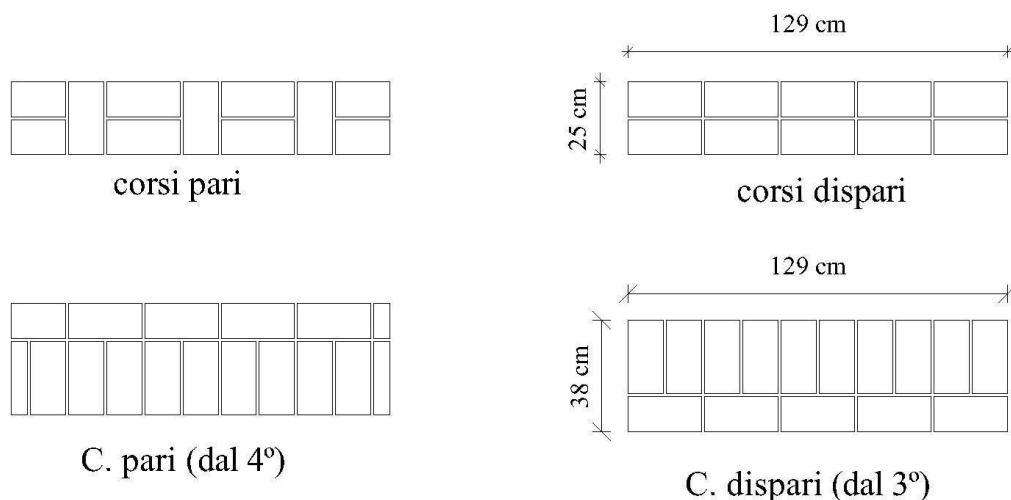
Disposizione dei laterizi in sezione orizzontale nei muretti a 2 teste (sopra) e 3 teste (sotto).
